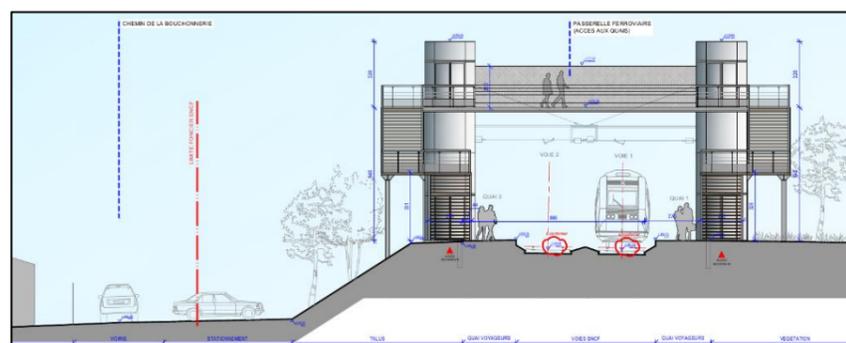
Puget Ville - Coupe de principe sur la passerelle (AREP, 2021)
